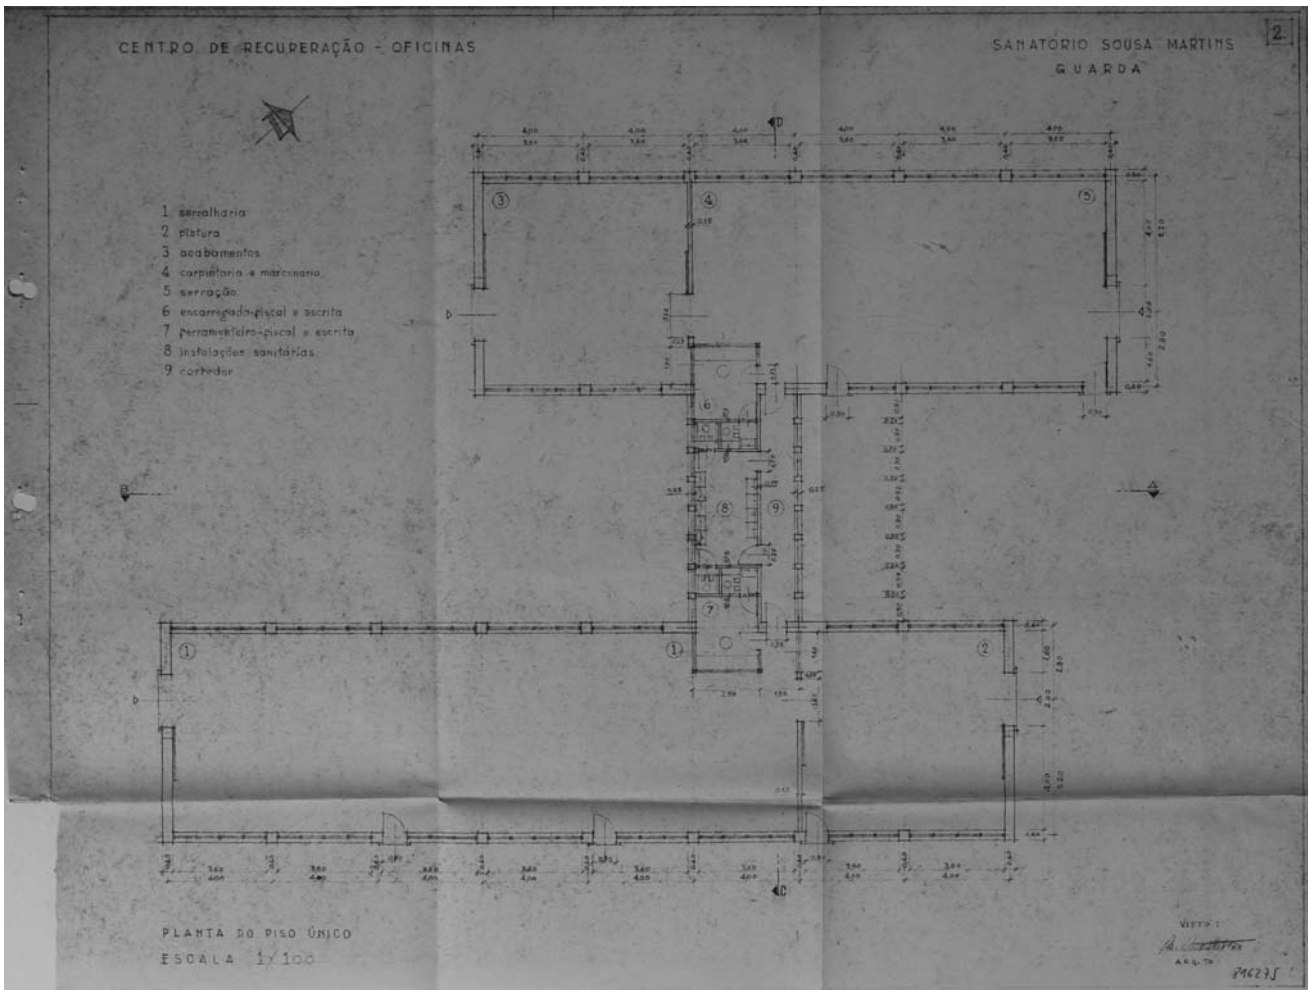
Centro de Recuperação - Oficinas. Planta do Piso único. M. Montalvão. SIPA: DES\_816275.
